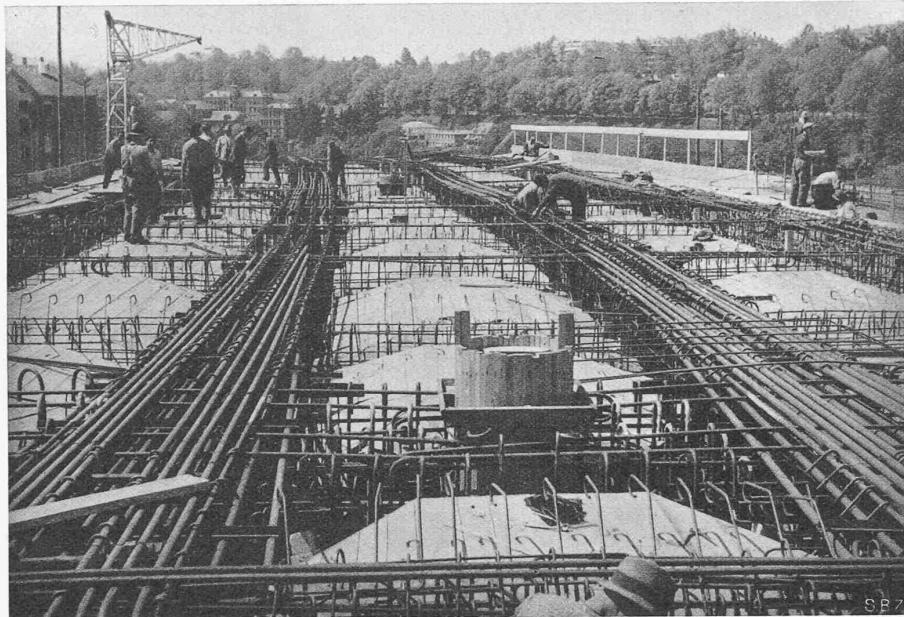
Bewehrungen des Rahmens bei Pfeilern 6,8 für die Längs- und Quertragwerke.
